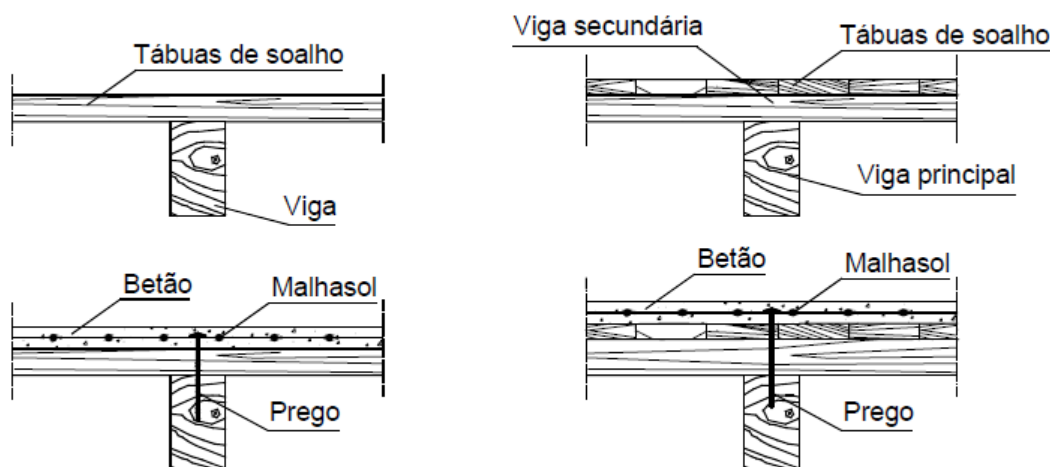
Esquemas de laje de madeira e laje mista madeira-betão (Branco, 2003)
